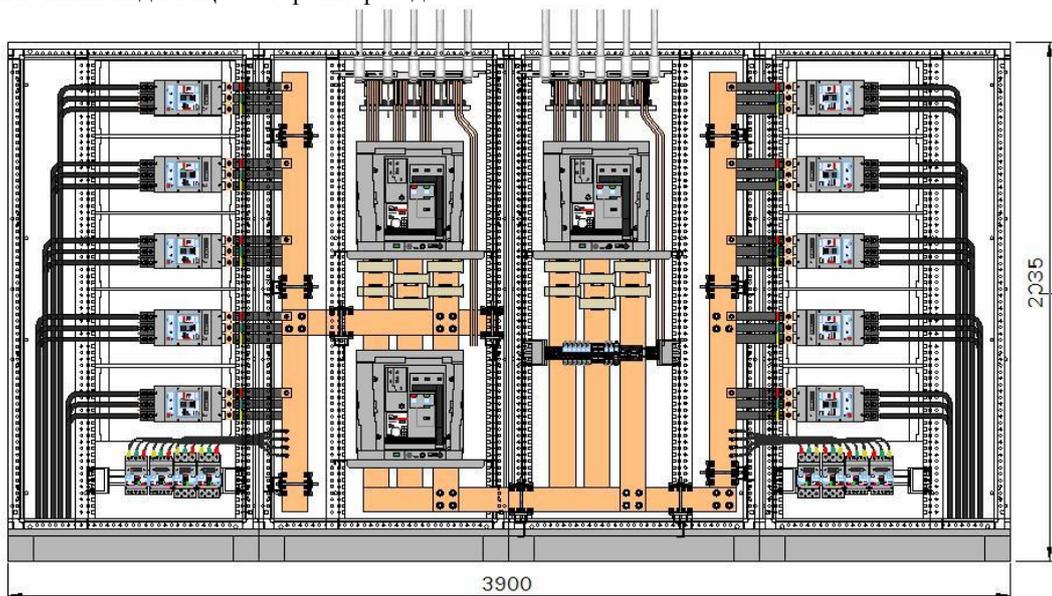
Внешний вид ГРЩ со стороны фасада без дверей и фальшпанелей
